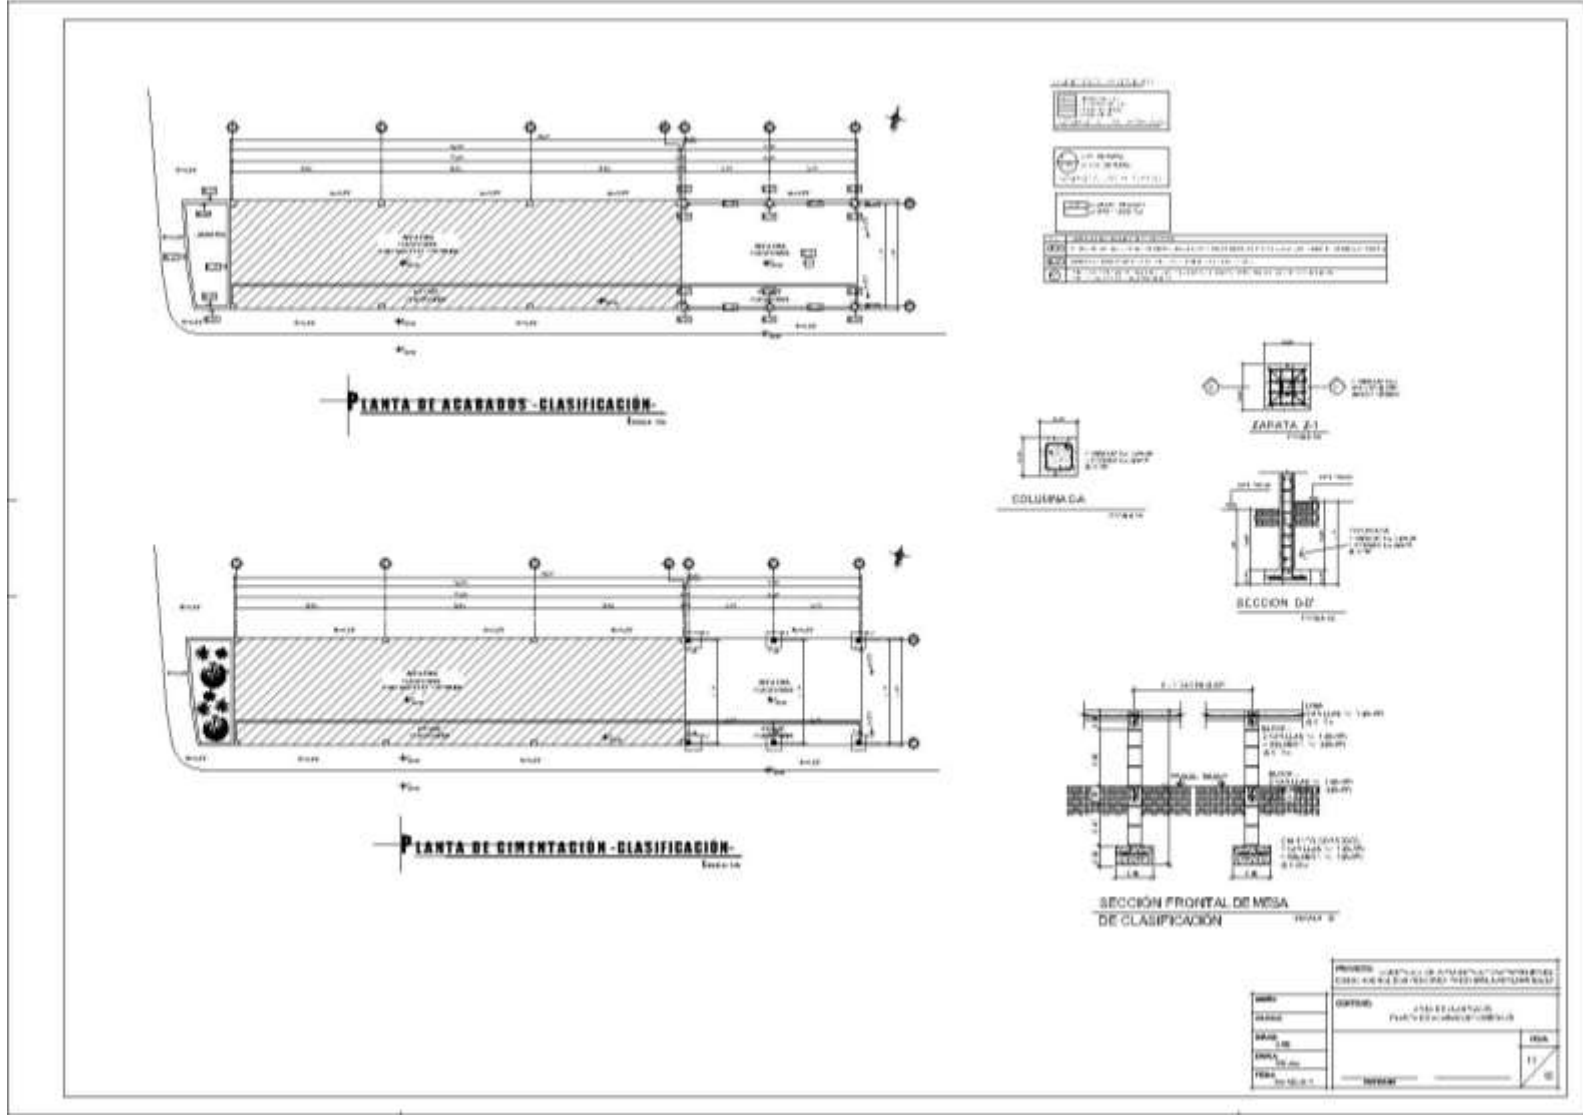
Área de clasificación planta de acabados y cimentación.
